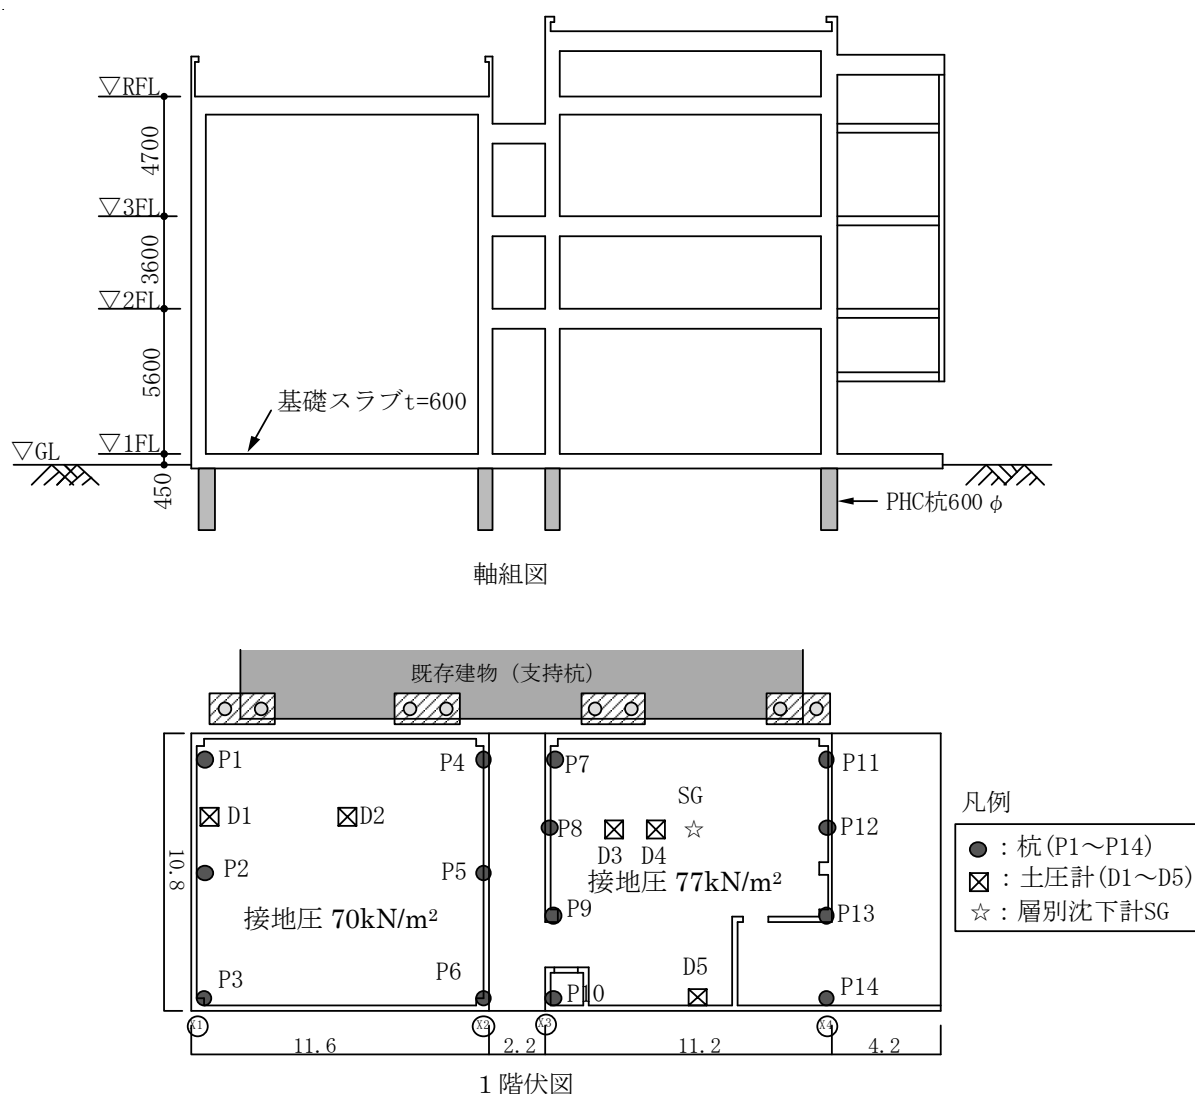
建物平面図、杭配置図、層別沈下計測及び接地圧計測位置
